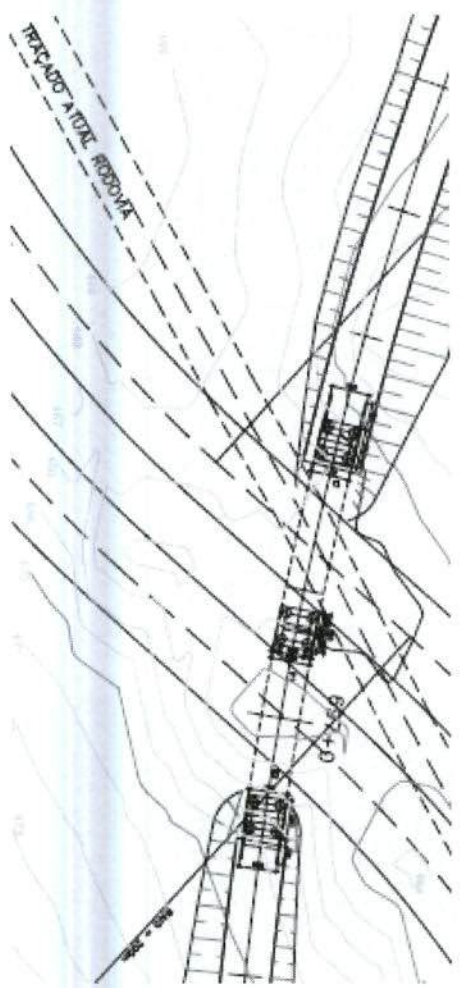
Projeto do viaduto sobre a BR 349 (planta de situação)
